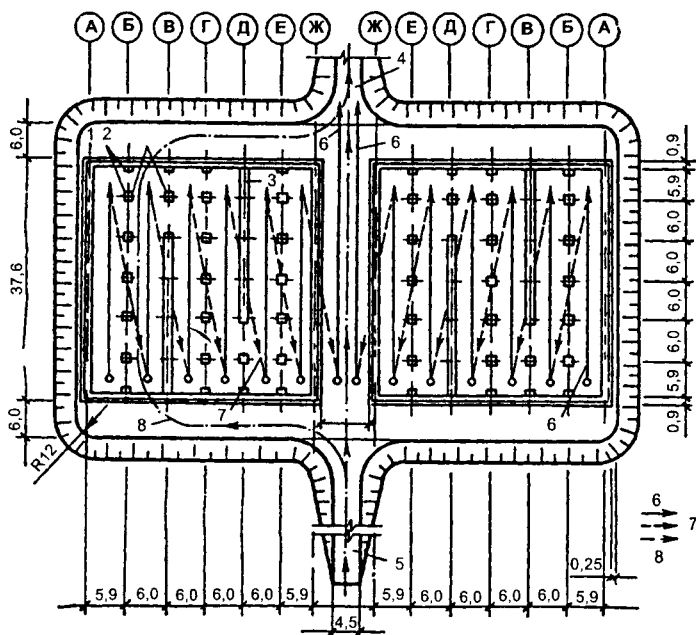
Схемы движения монтажных кранов при возведении двух крупных резервуаров:
